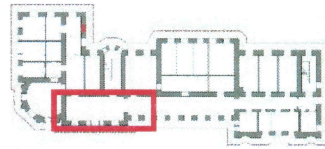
Междуэтажные плоские перекрытия, кирпичные перемычки оконных и дверных проемов
